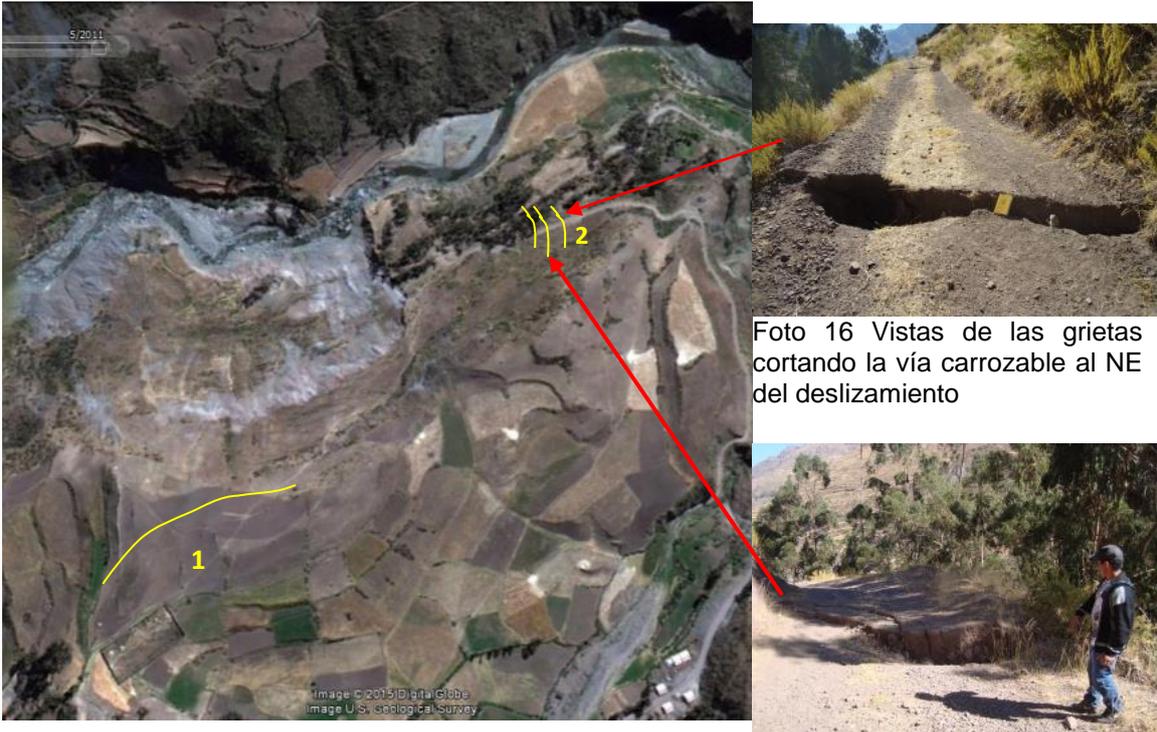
Vistas de las grietas cortando la vía carrozable al NE del deslizamiento
